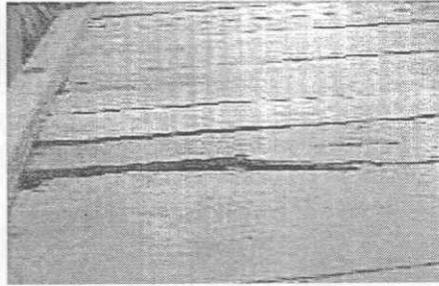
Superficie en madera deteriorada. Puente Río Balsillas (Huila).
